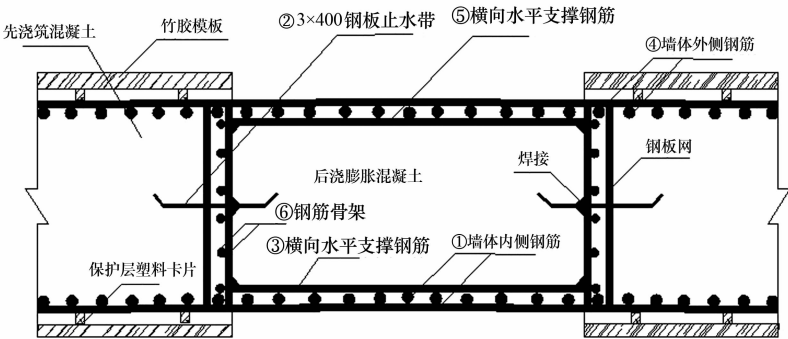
地下室剪力墙后浇带施工缝构造措施平面示意图
